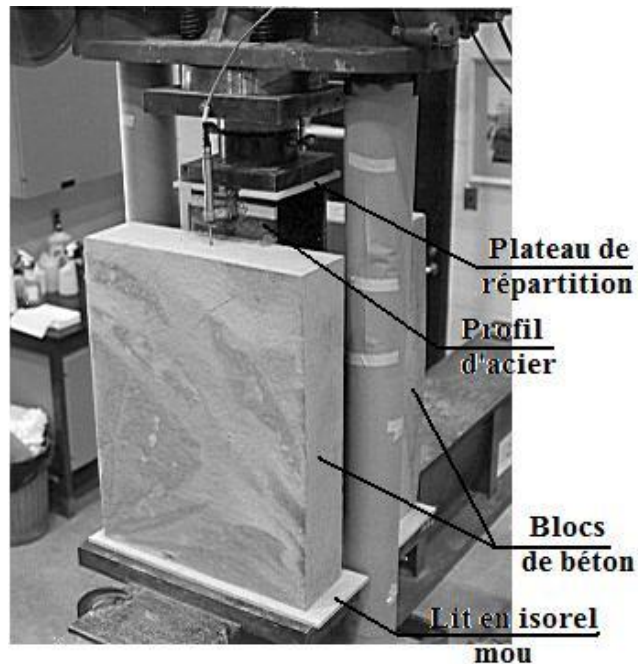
Dispositif de l'essai Push-Out. [1]
